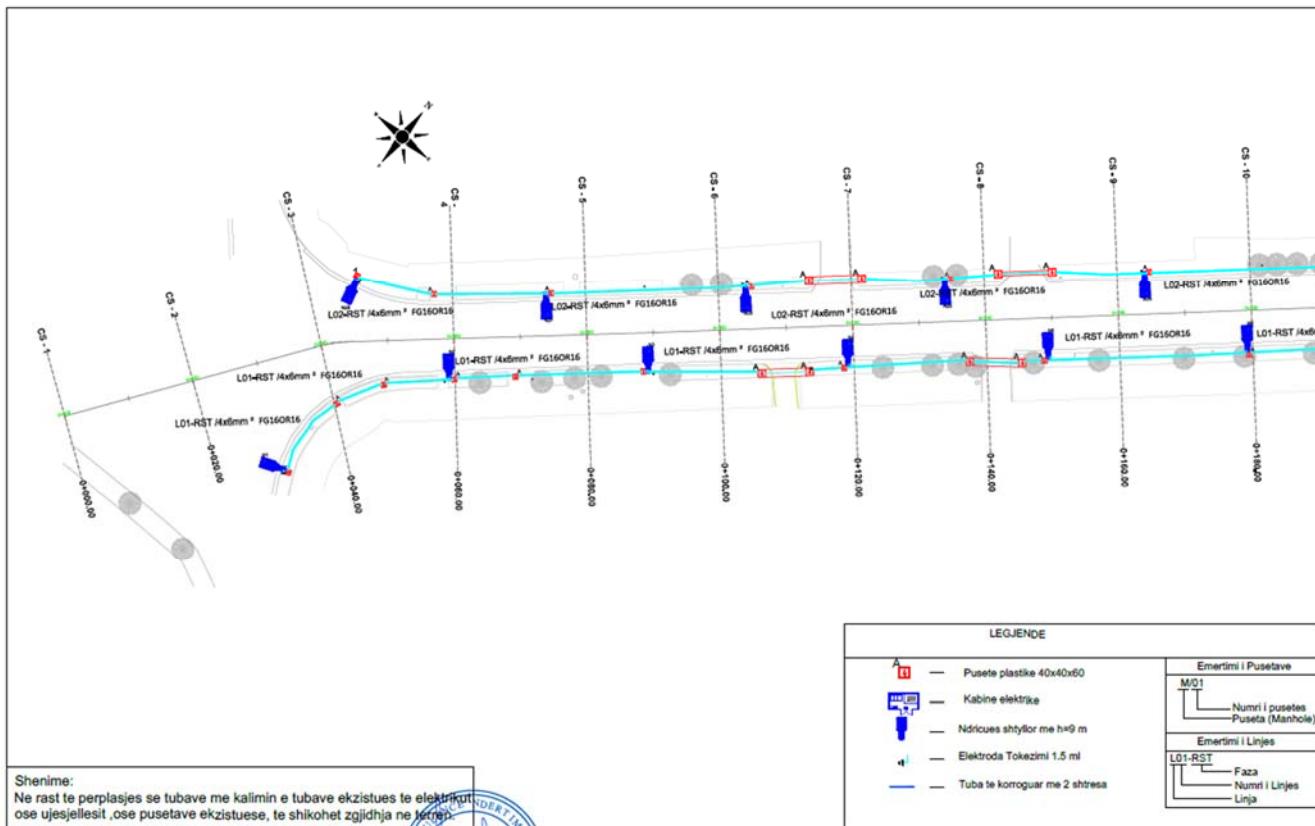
Planimetria e ndricimit ruga “Kolë Heqimi“
